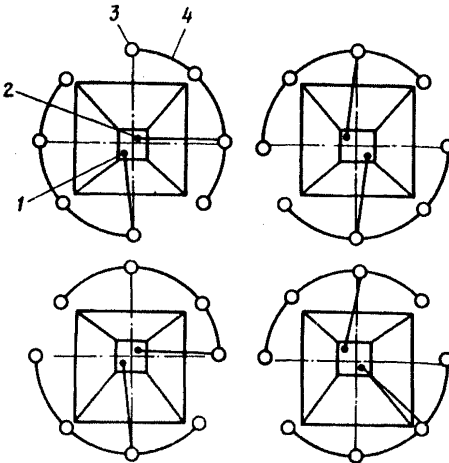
Размещение протекторов при защите арматуры фундамента опоры ВЛ от коррозии:
